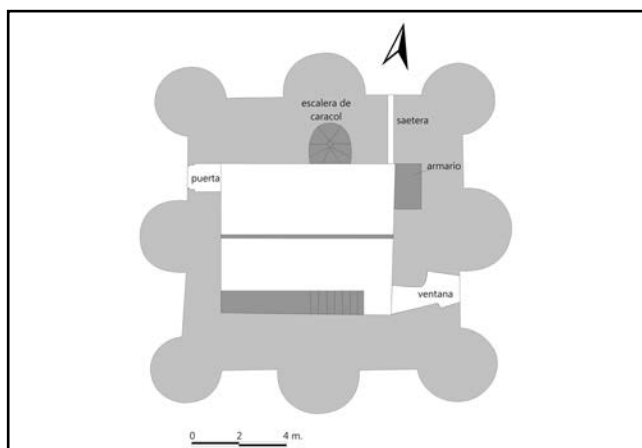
Hipótesis de reconstrucción de la planta primera de la torre del homenaje.
